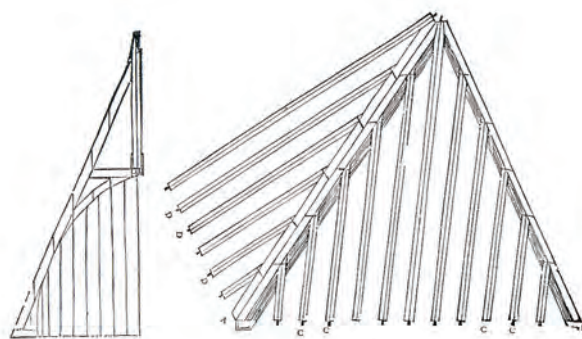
Planche de Trait représentant une croupe de toiture (JOUSSE 1627, p. 71).
